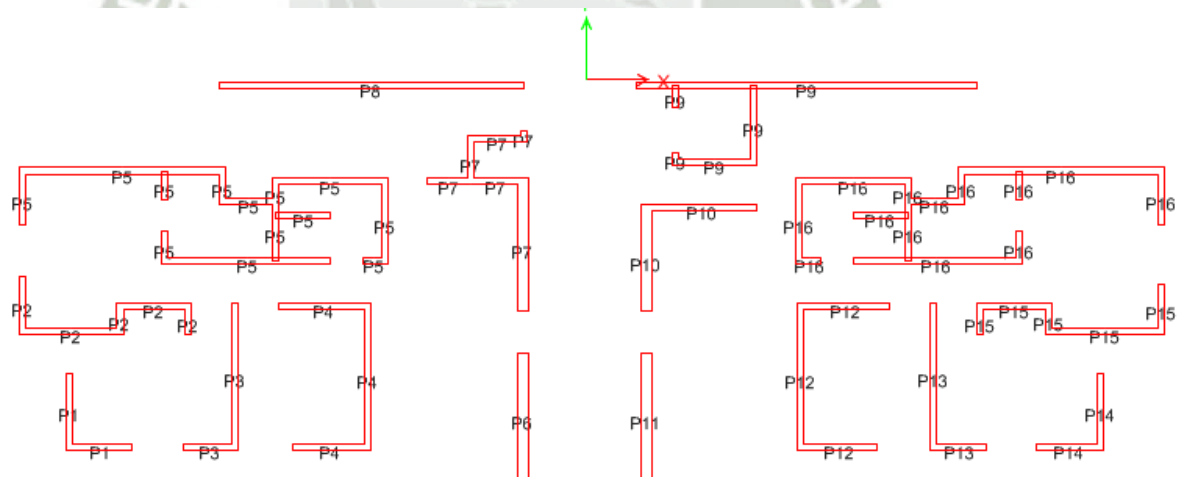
Asignación de Etiquetas a los muros del Primer bloque
